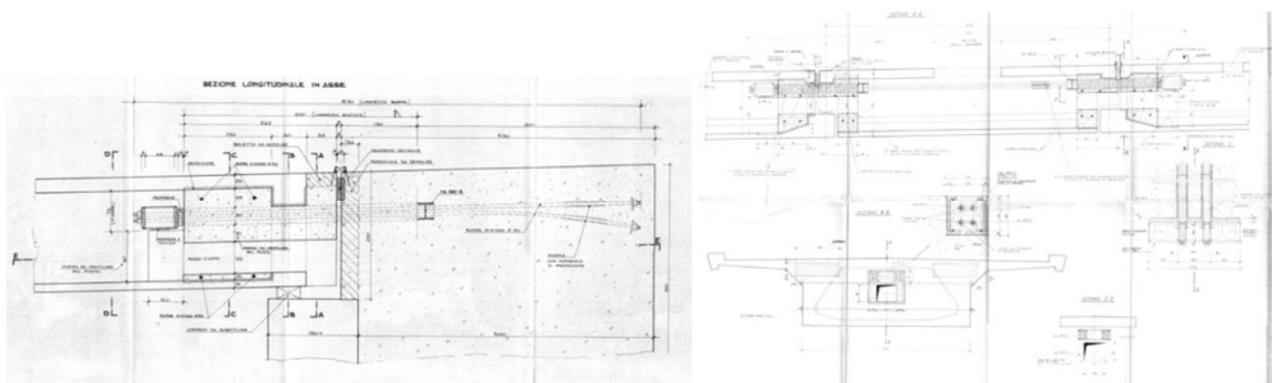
Collegamento spalla lato Celico a) Collegamento travi tampone b)
